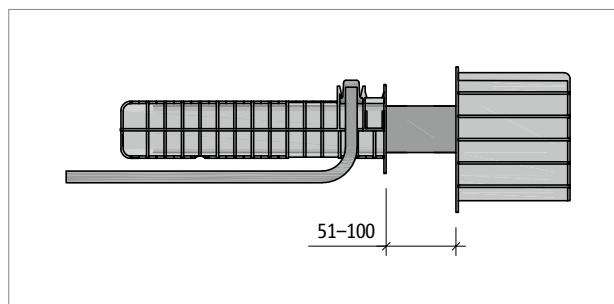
Schöck Tronsole® typ Q: Varianta se šikmou polohou nosného profilu
